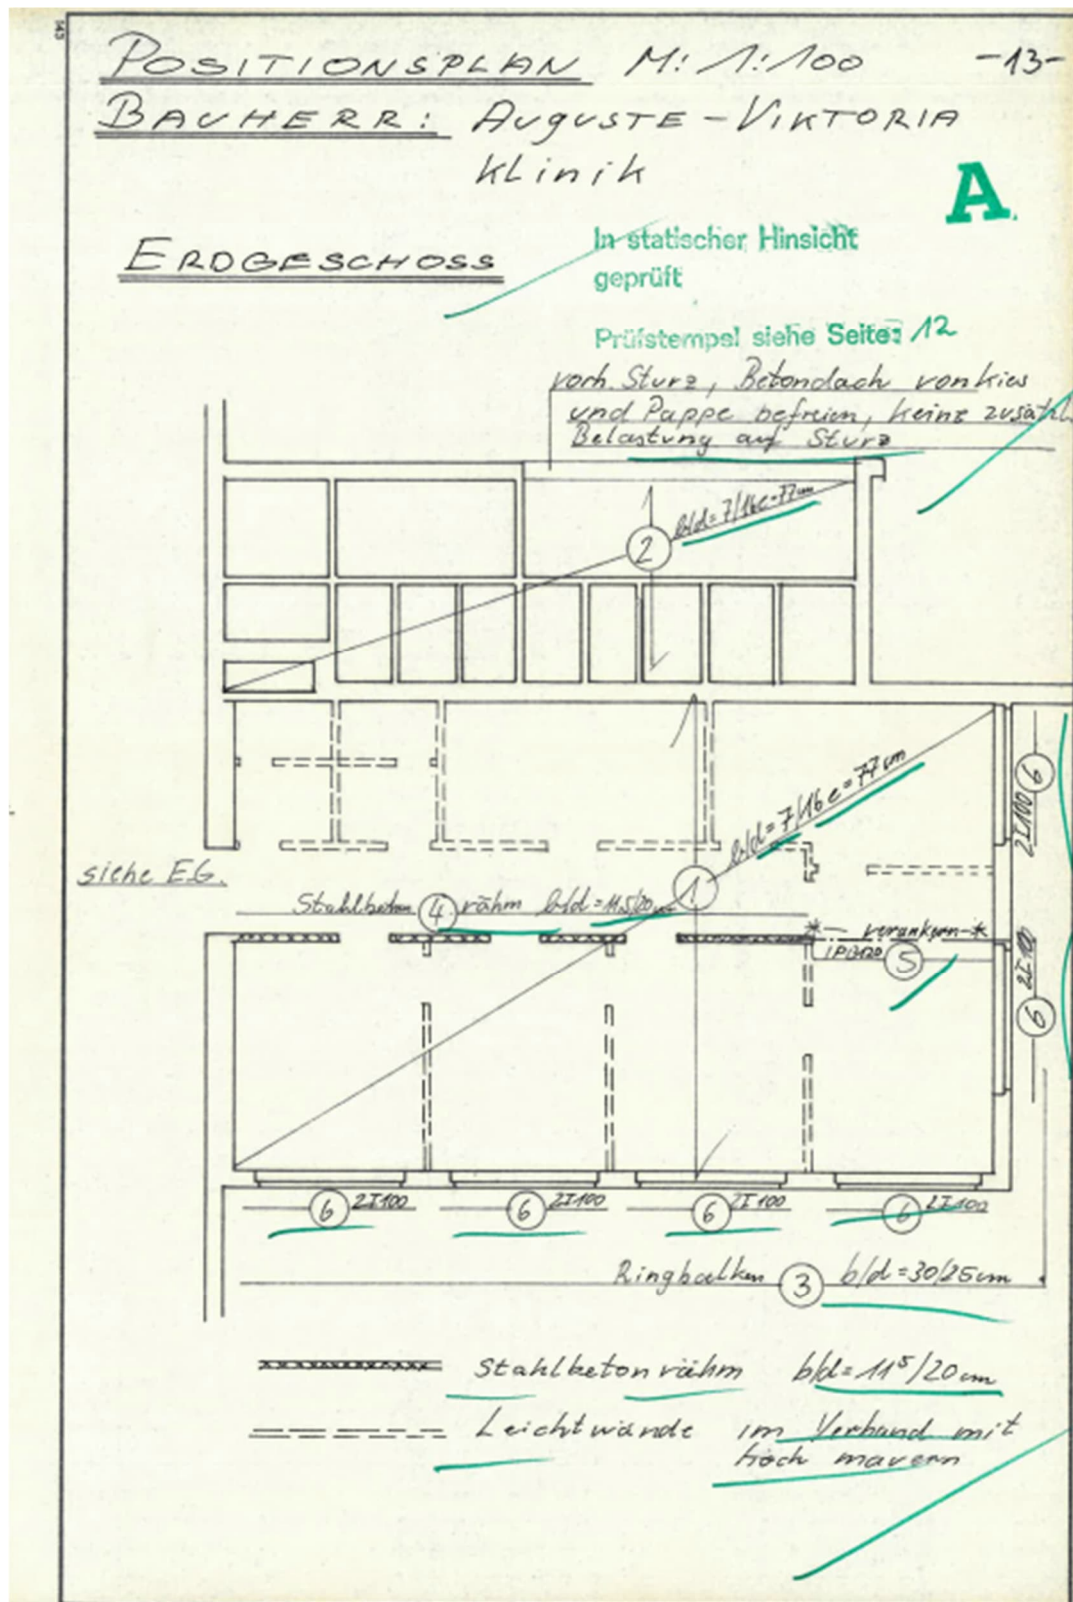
Positionsplan Seite 13 der Statik Erdgeschoss vom 29.10.1980
